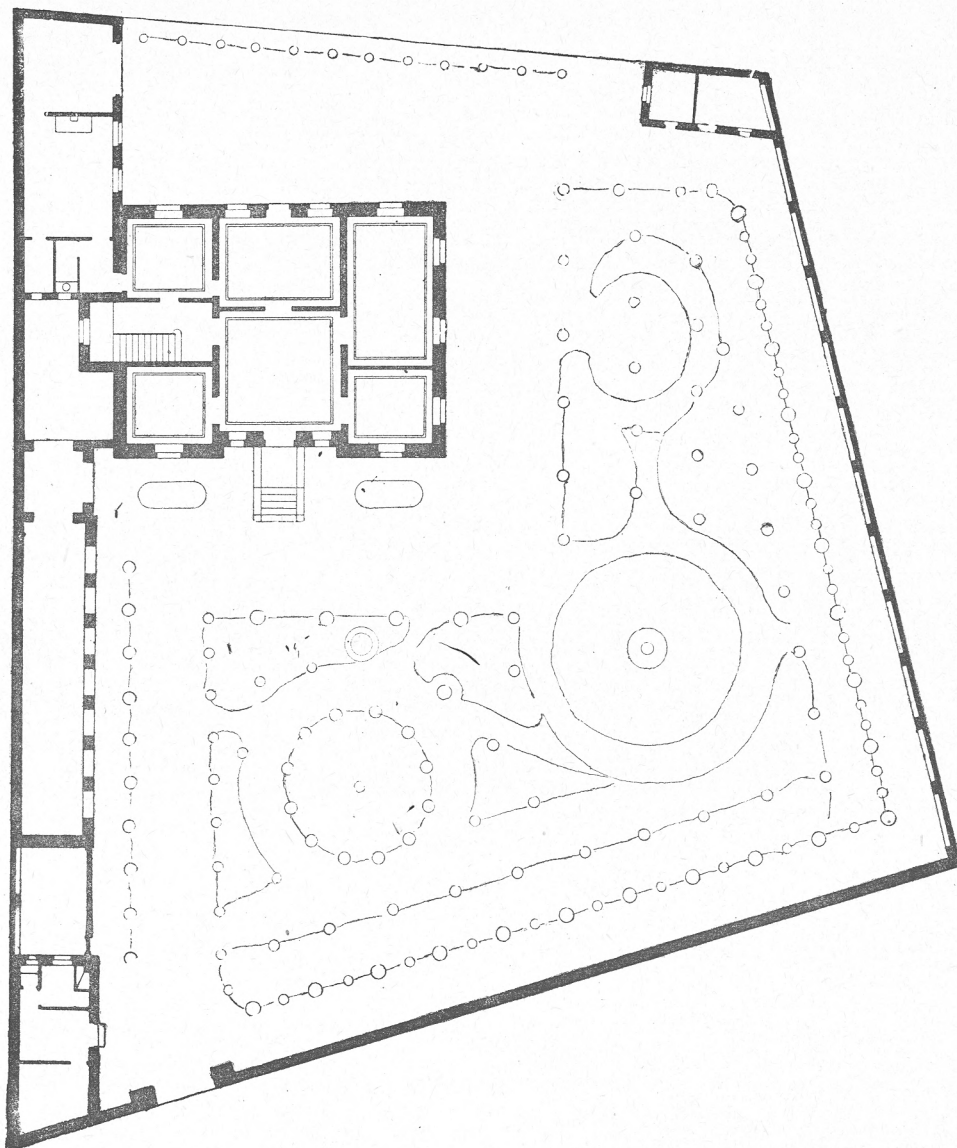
Hotel de Rodríguez Ayuso. Planta baja.
